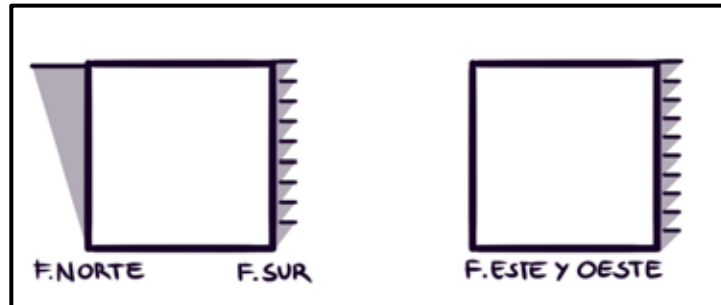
Métodos alternativos de protección solar a las fachadas, La autora, (2016)
